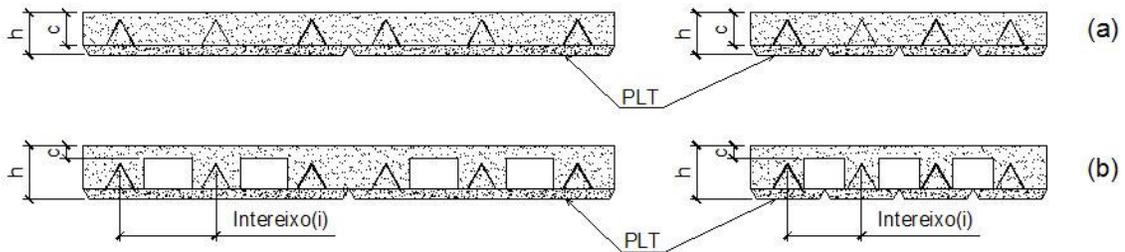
(a) laje maciça com pré-laje treliçada (b) laje maciça com pré-laje treliçada e elemento de enchimento
